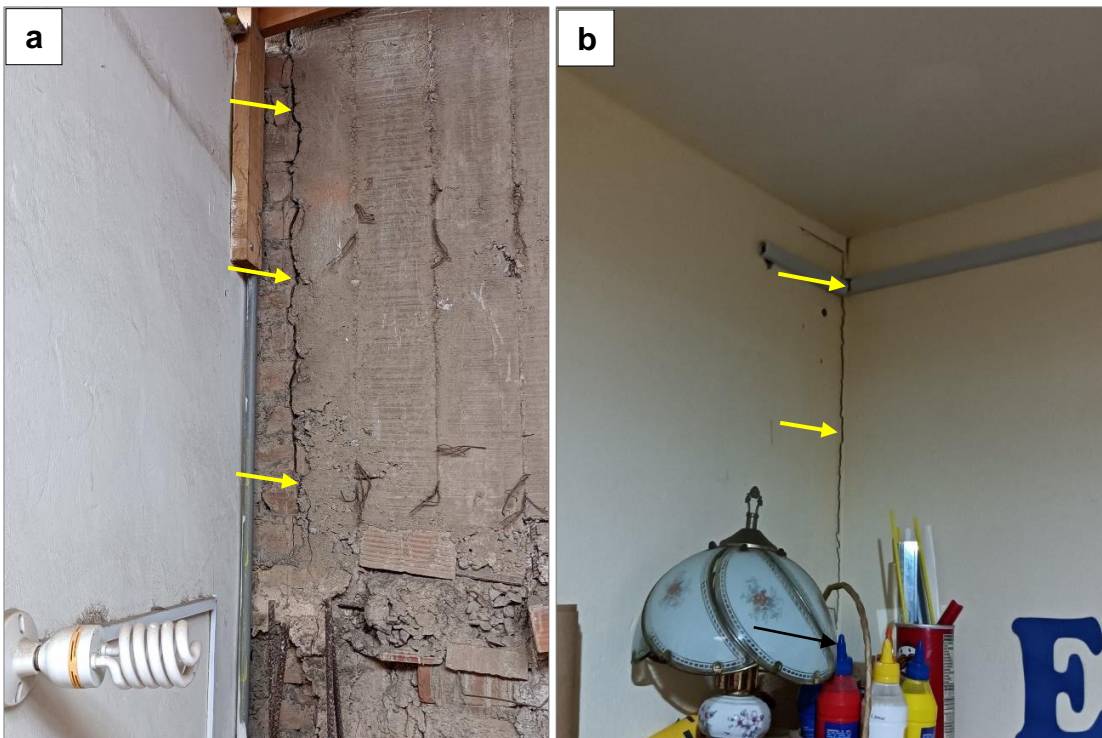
a y b) Grietas en columnas con separaciones de hasta 2 cm.
